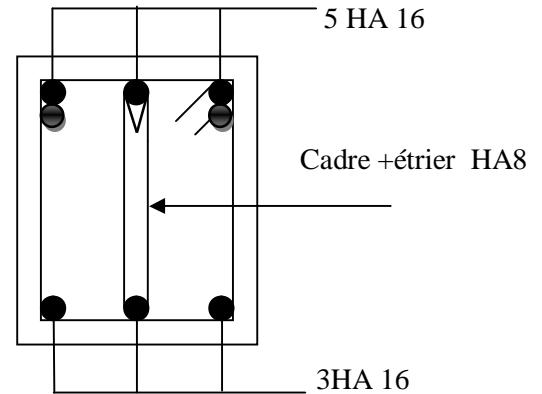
Schéma de ferraillage de la poutre palière.
